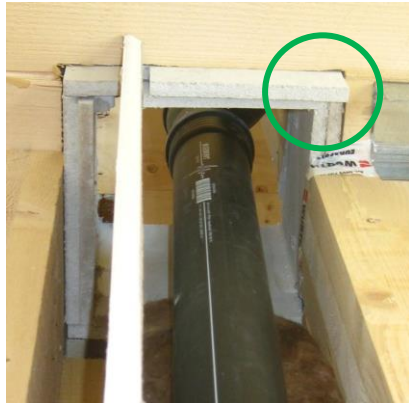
Eckiger Durchbruch mit GF-Platten
